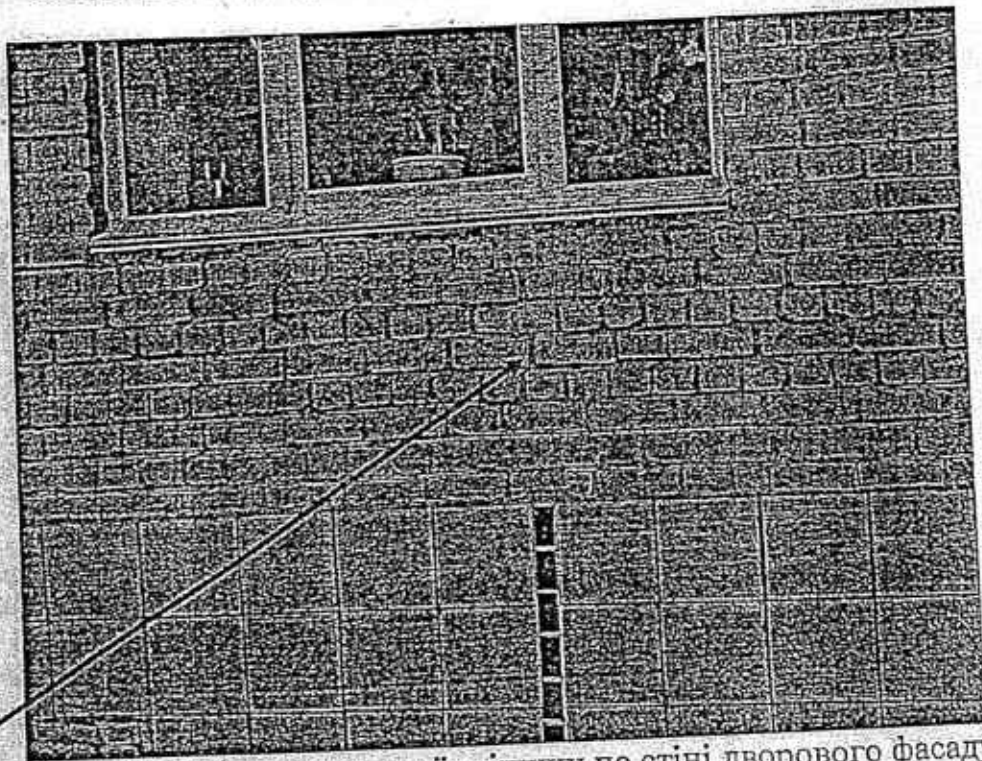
Розкриття локальної тріщини по стіні дворового фасаду.
